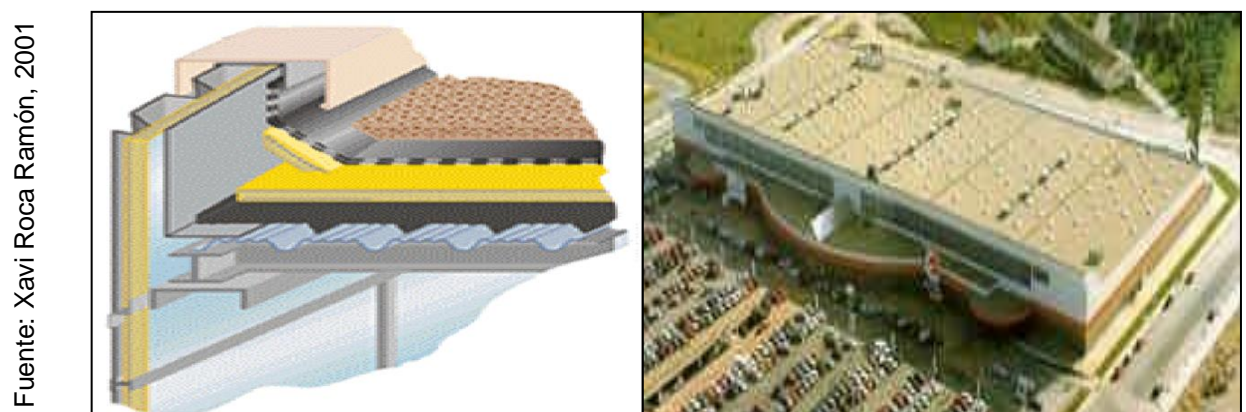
Cubierta tipo deck y edificio con cubierta plana deck.
